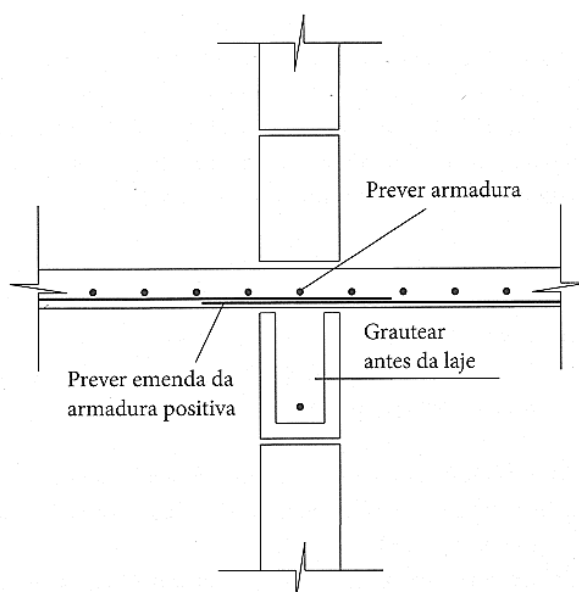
Detalhe da armadura de laje maciça sobre apoios.
